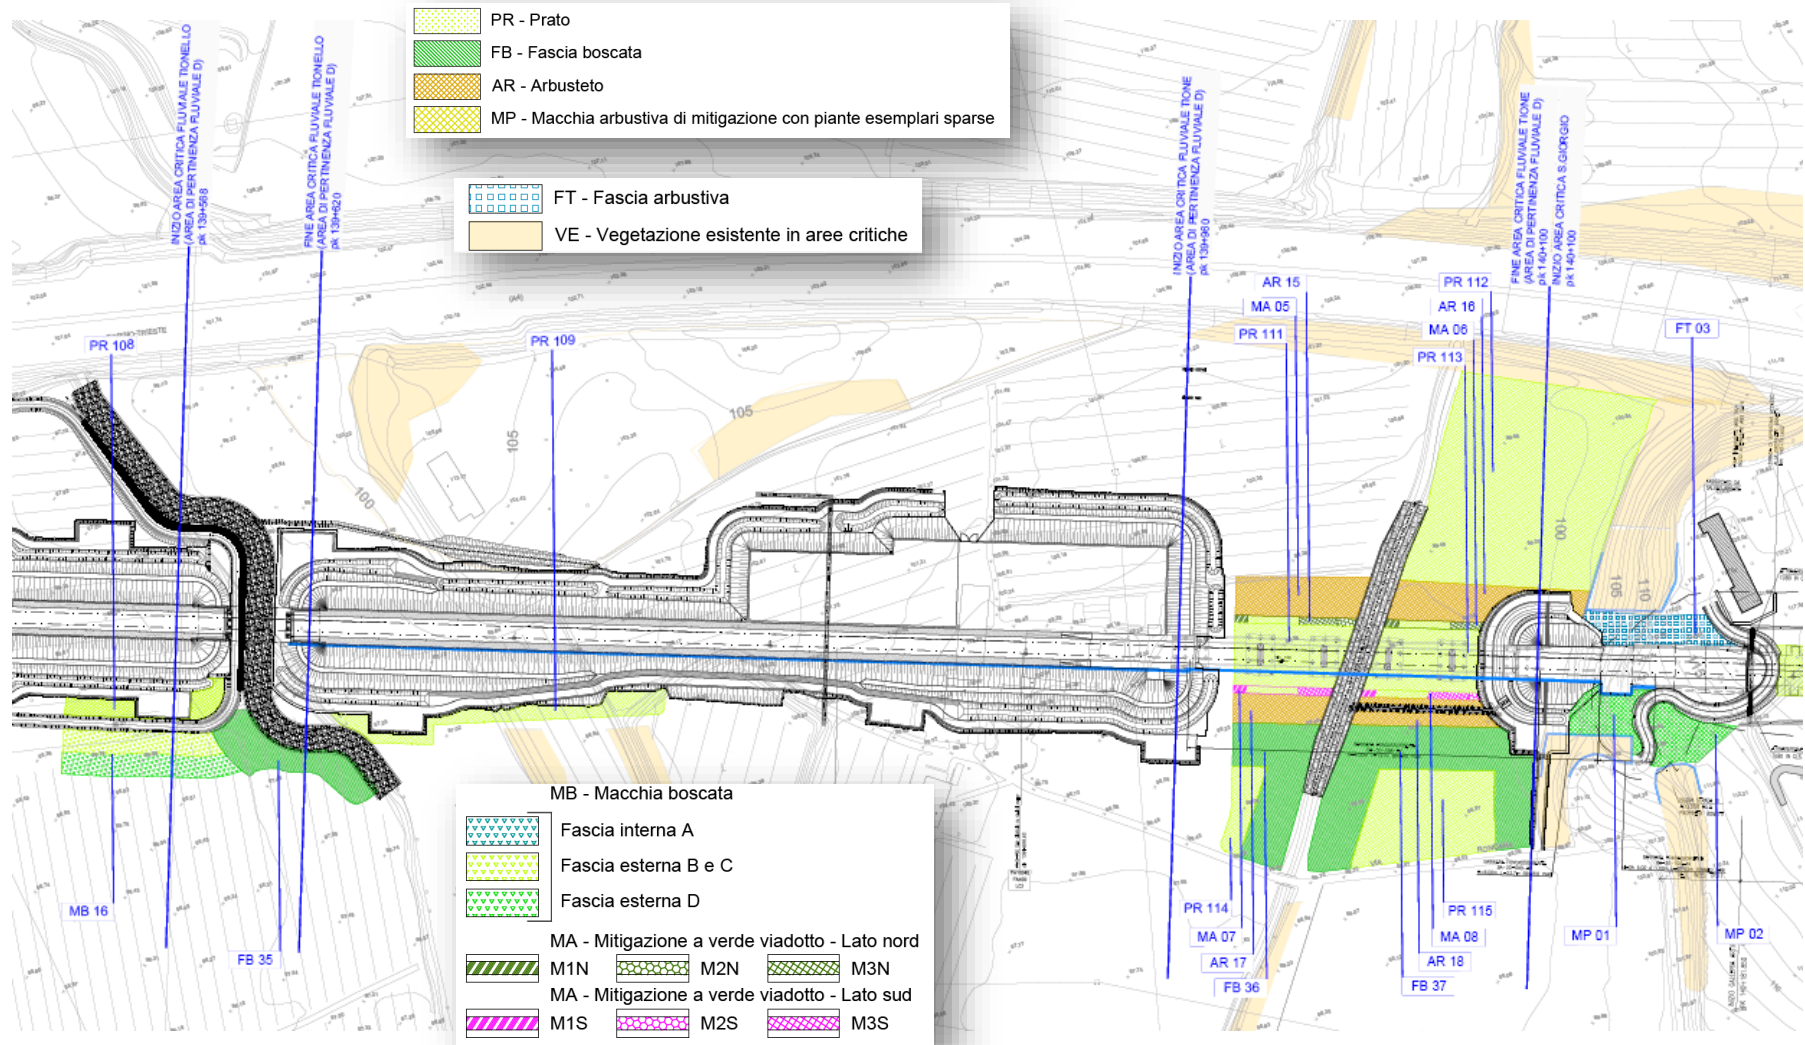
stralcio della planimetria degli interventi di inserimento paesaggistico dei viadotti Tionello e Tione
